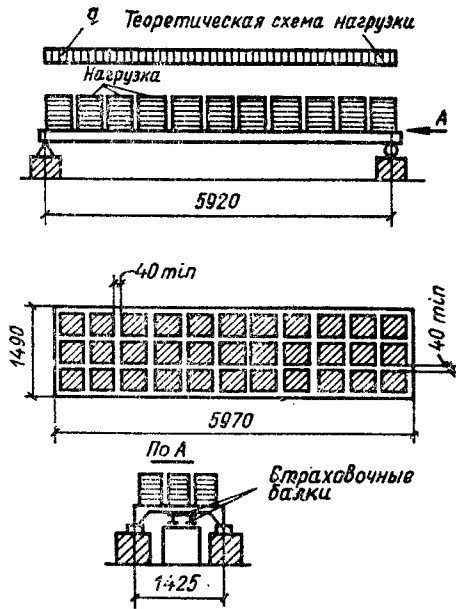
Схема испытания армированной ребристой плиты из ячеистого бетона распределенной нагрузкой
